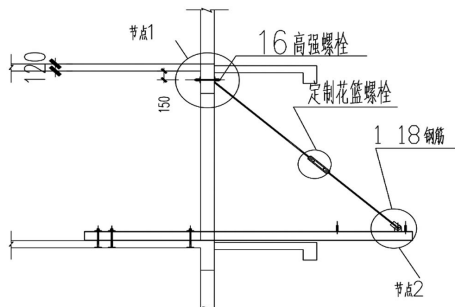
连廊或阳台部位斜拉搁置梁脚手架工字钢固定做法剖面图
